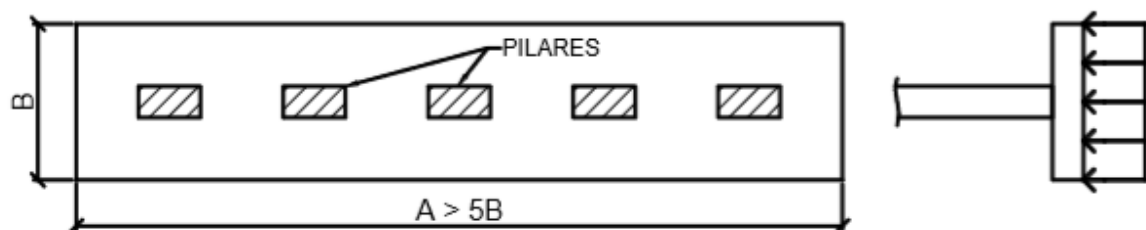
Sapata corrida para apoio de pilares alinhados
